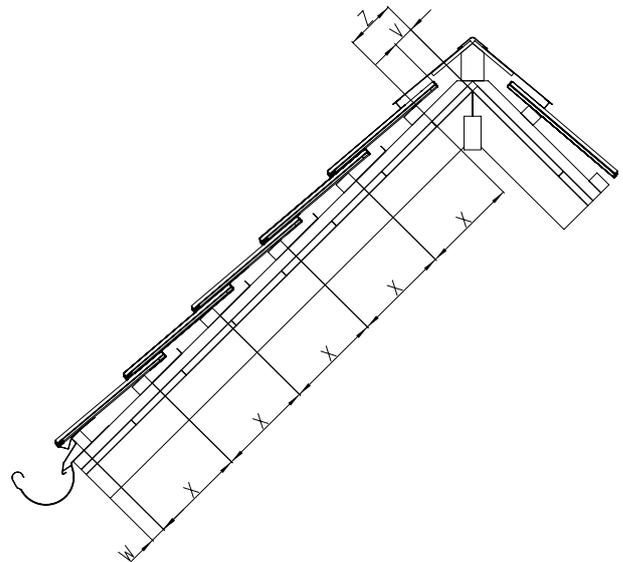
Profilschnitt mit Maßen für die Montage auf einem Dach mit First
